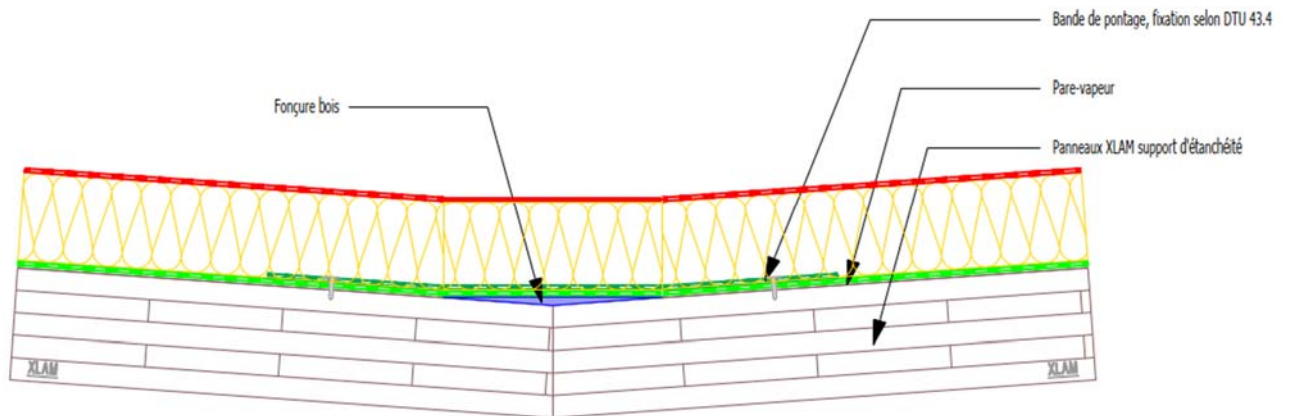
Exemple de traitement d'un joint de dilatation en toiture chaude accessible aux piétons et au séjour
